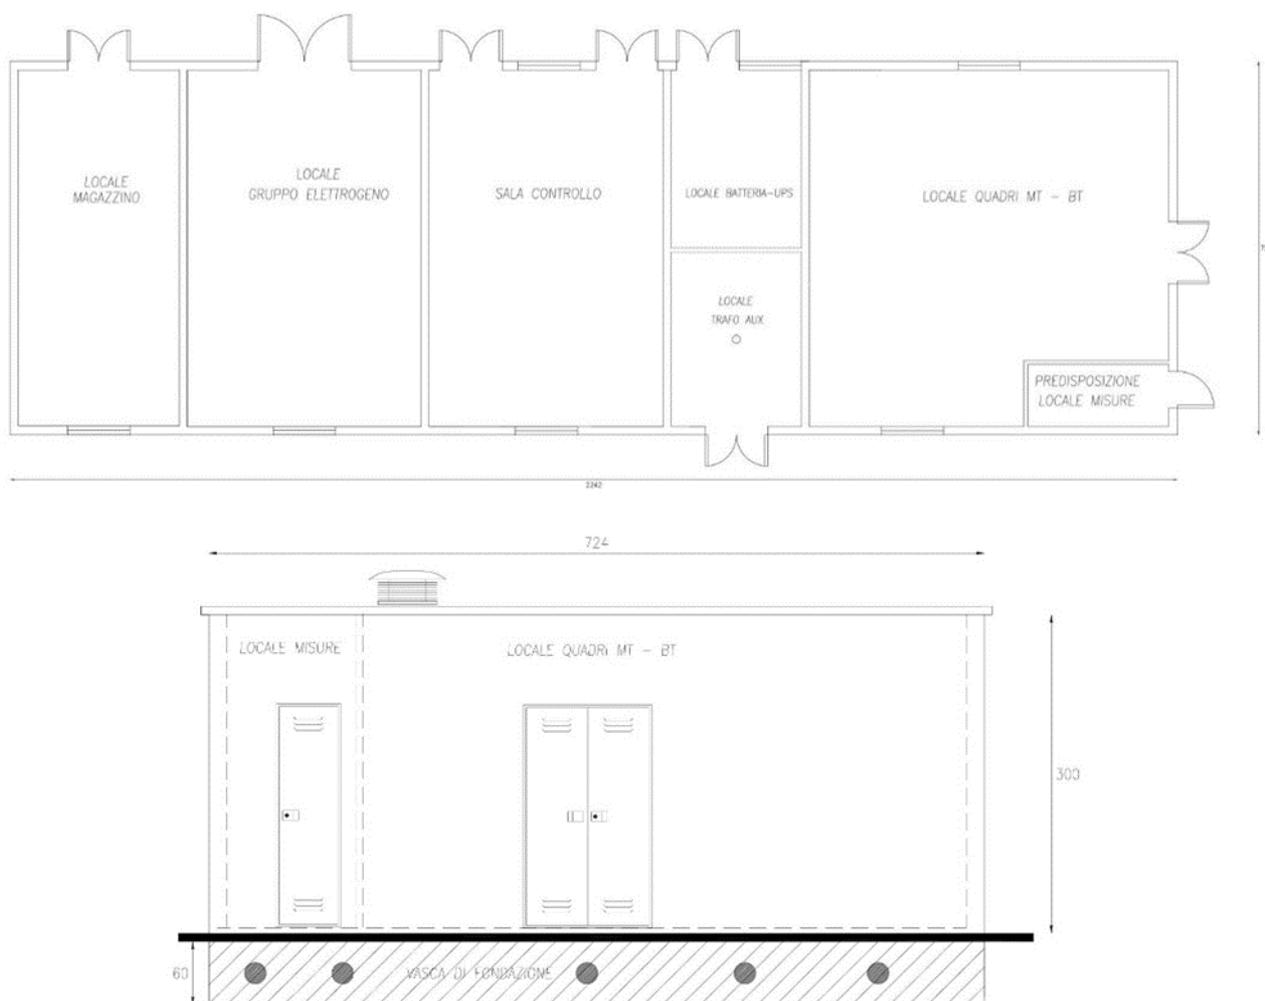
Pianta e Prospetto della Cabina Generale Utente.
